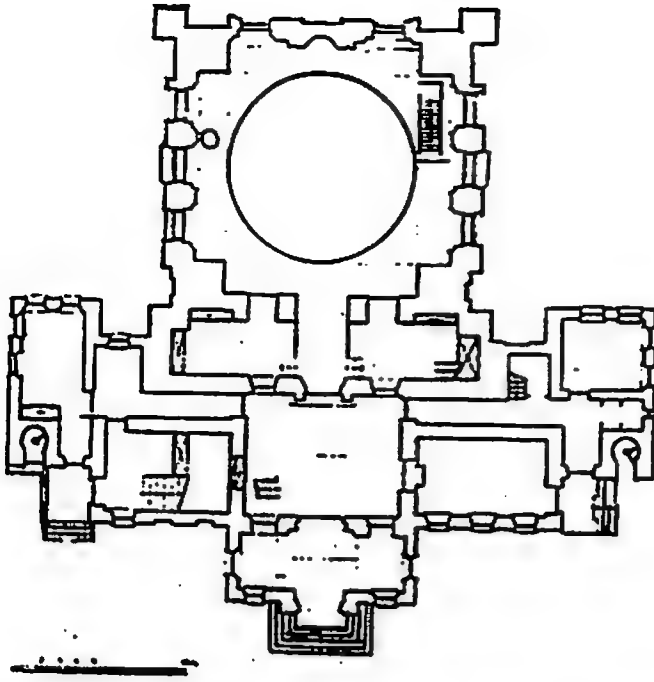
المسقط الأفقي لجامع آياصوفيا — إسطنبول .
